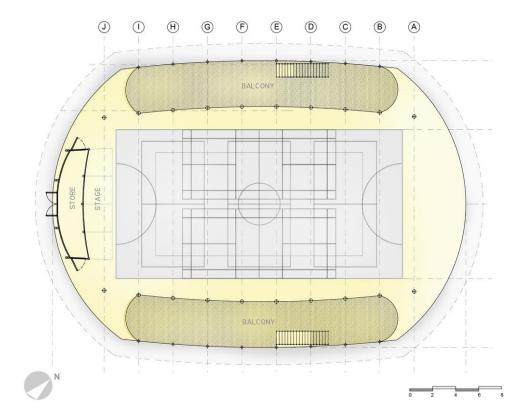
Planta Arquitectónica Bamboo Sports Hall
